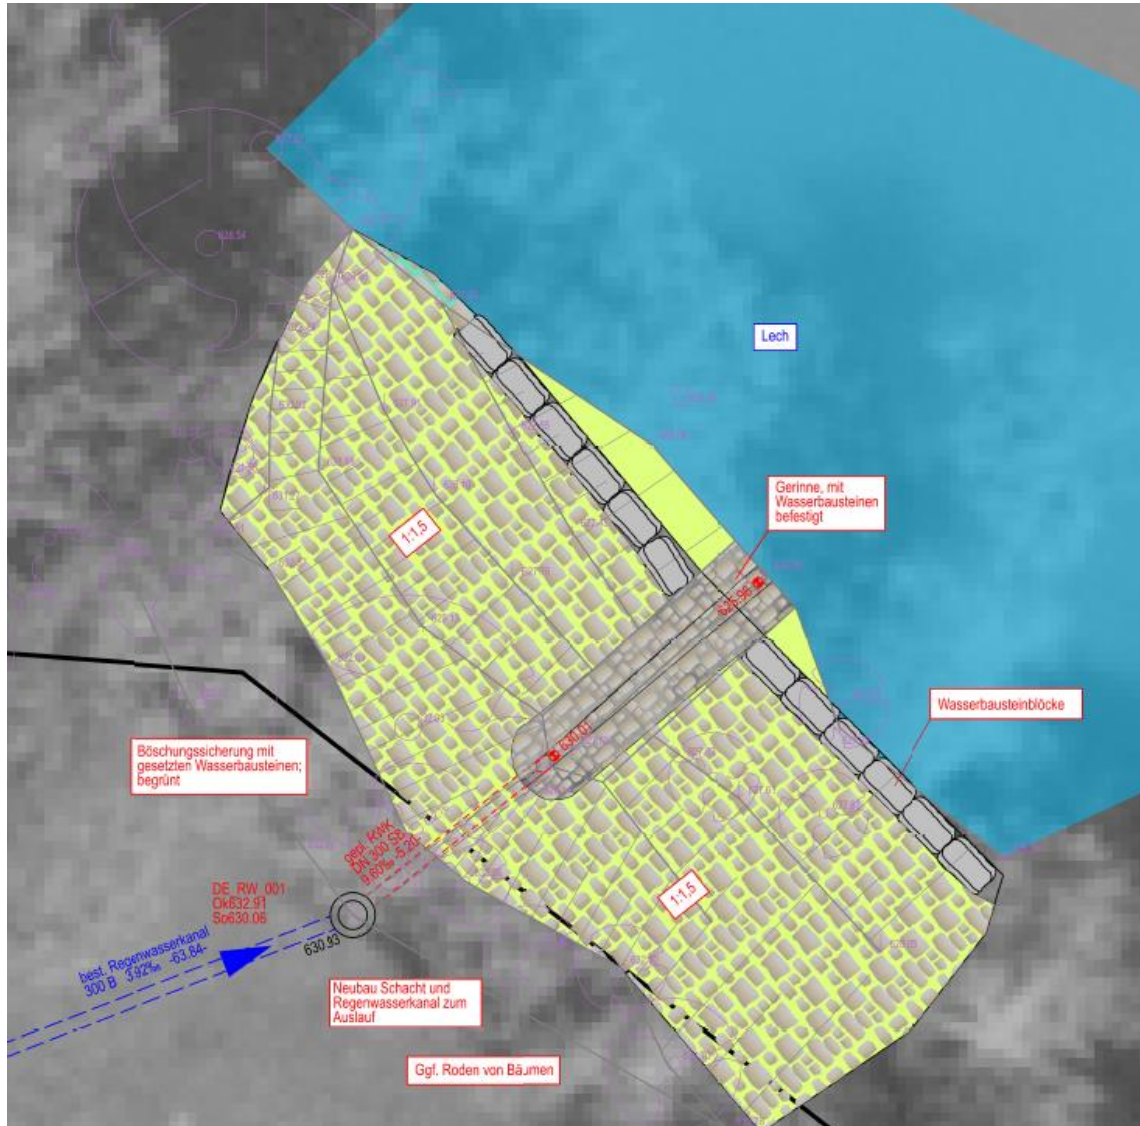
Ausschnitt aus dem Lageplan 118127-01-HW
